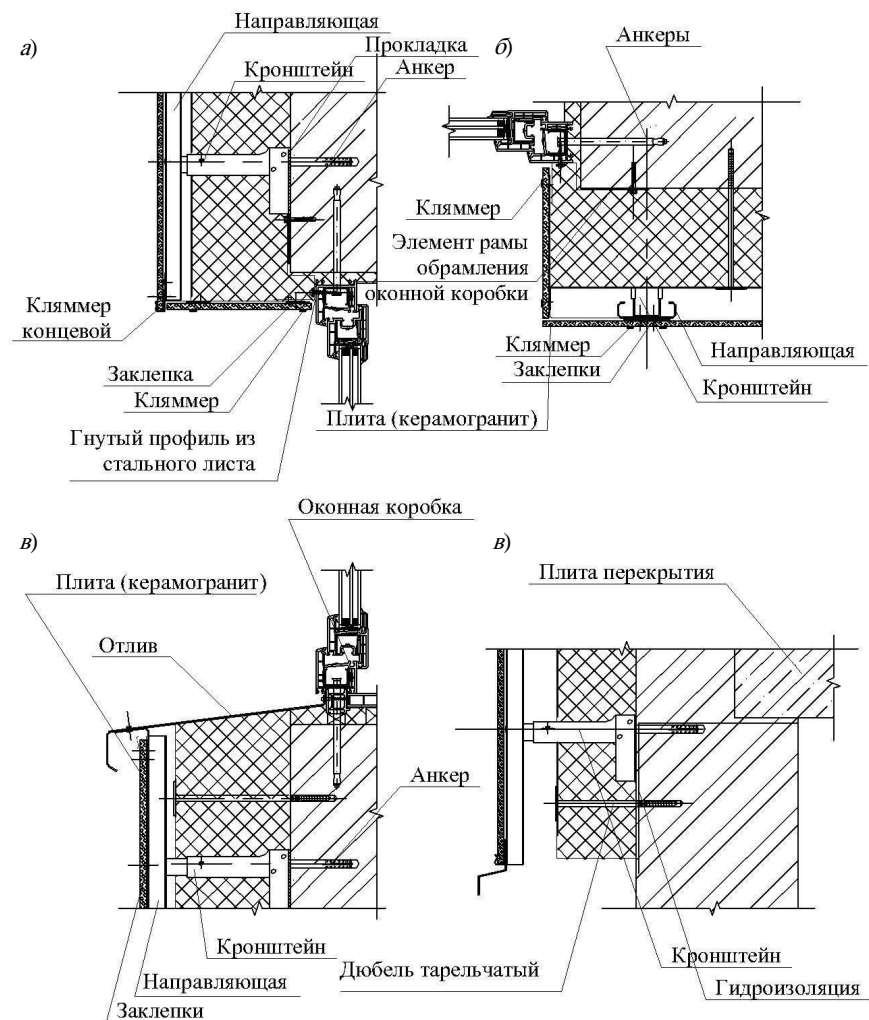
Конструктивное решение узлов при утеплении с наружной стороны навесной фасадной системой «Newton Systems»:
